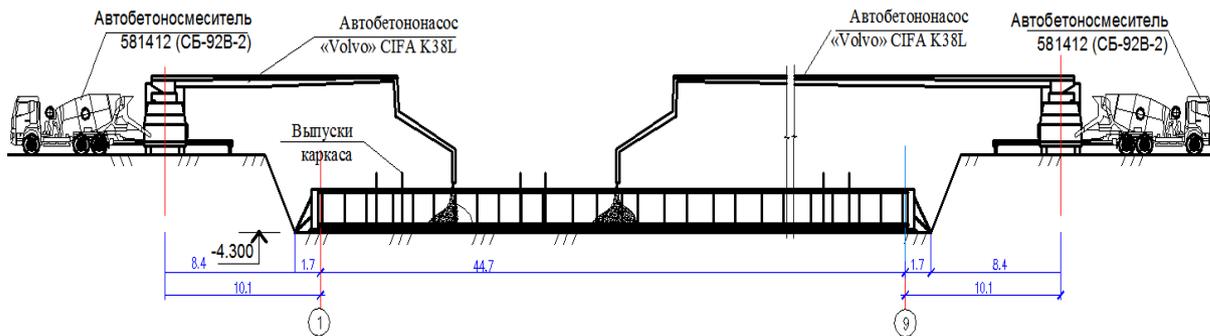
Подача бетона в конструкцию бетононасосом
